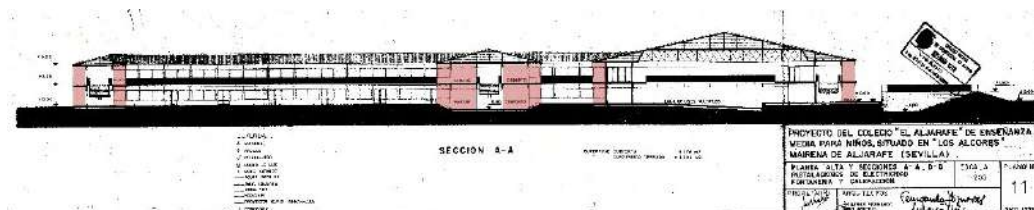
Galerías exteriores sobre una de las secciones de la planimetría original del Colegio Aljarafe. Archivo Histórico del COAM.
